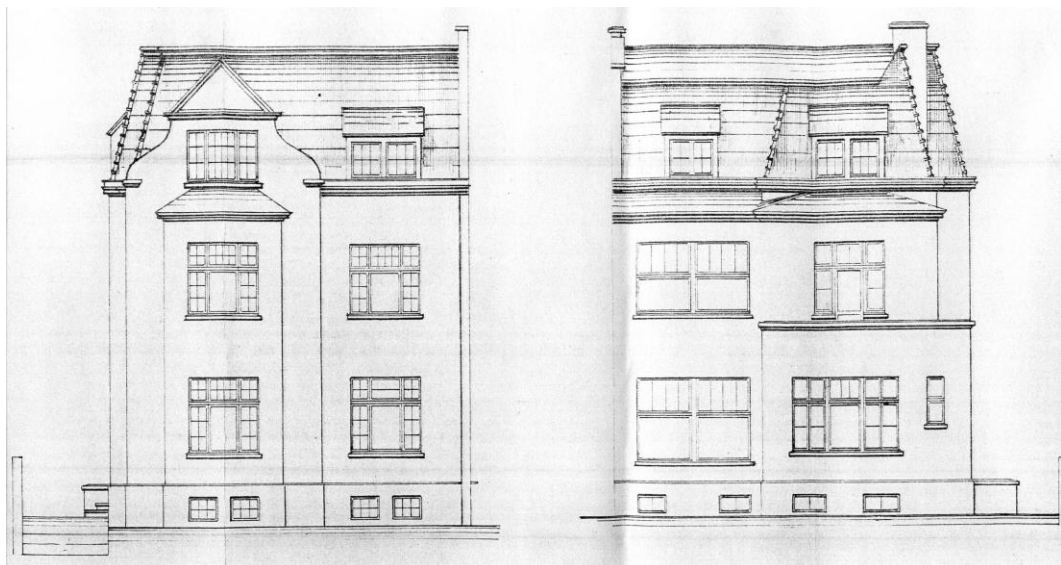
Bergstraße 91, Villa Direktor Conrad Janßen, Vorderansicht (l.), Hinteransicht mit eingeschossigem Anbau (r.) [TbaBO, Hausakte Bergstraße 91, Grundstückentwässerung, Umbau 1927]
